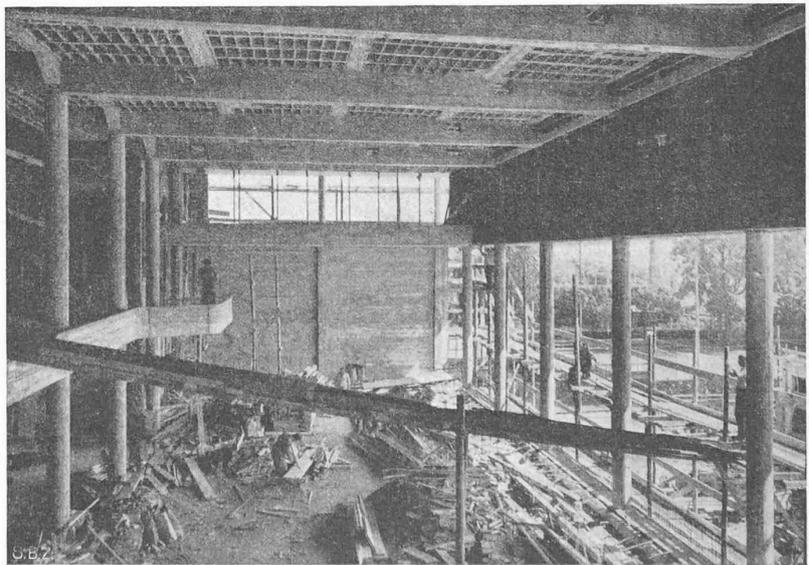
Foyertrakt im Eisenbeton-Rohbau (Seeseite rechts)
